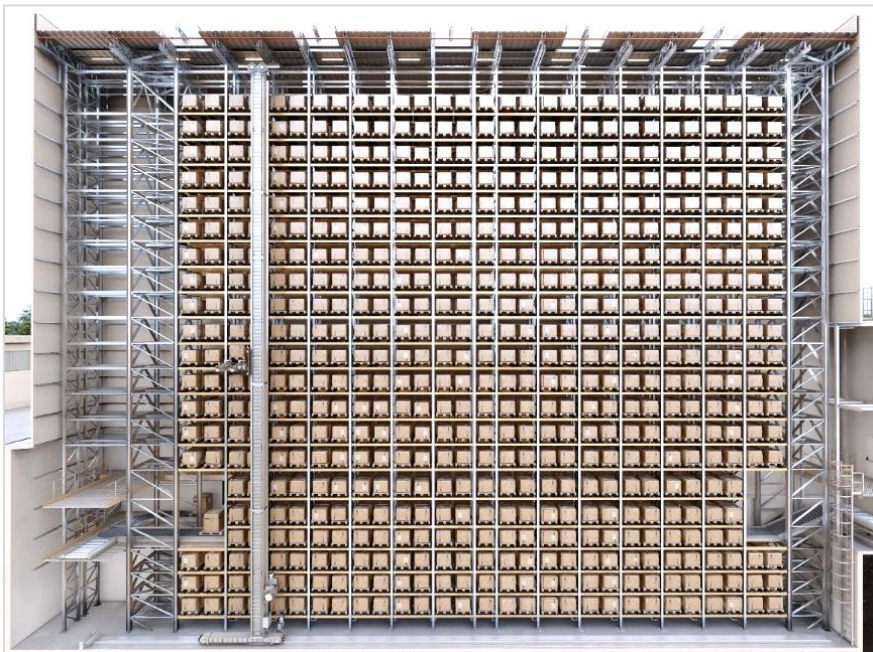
Sezione longitudinale magazzino automatizzato e baie di carico oggetto di analisi - Modello 3D
